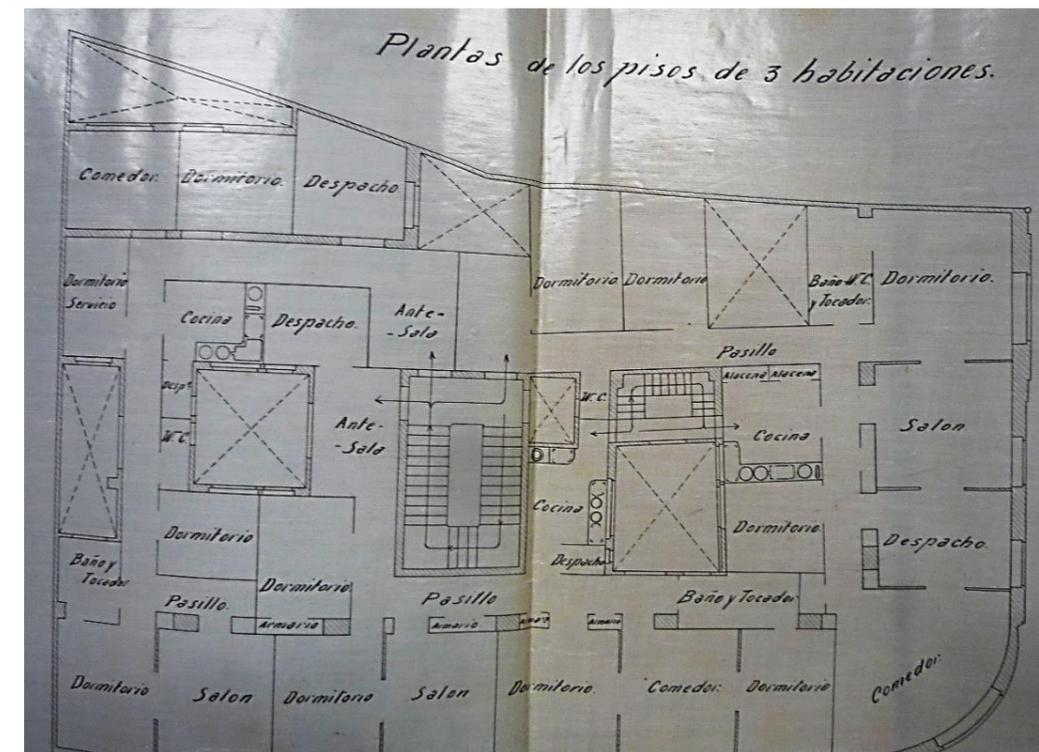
Plano original de la Planta Tipo, planta 1,2,3,y 4
